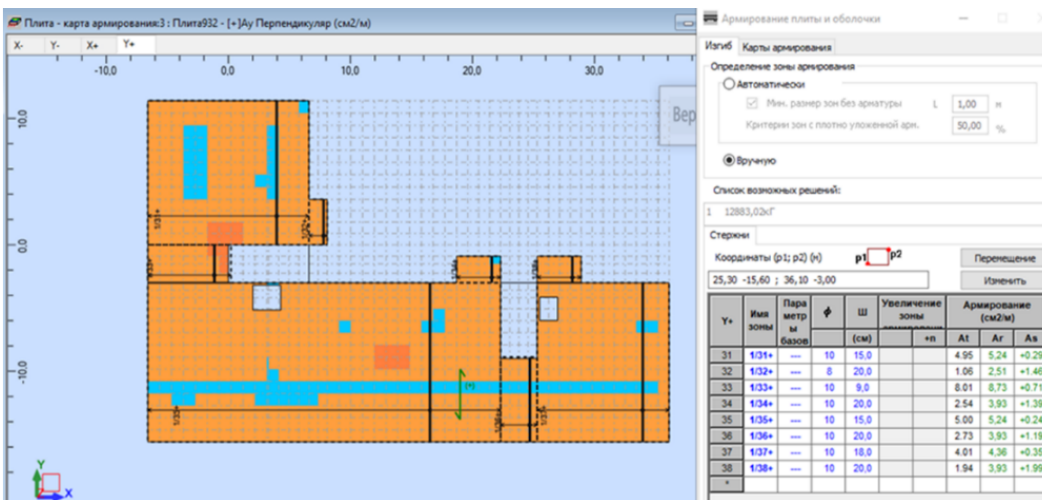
Верхнее армирование плиты по оси Y в ПК RSA
